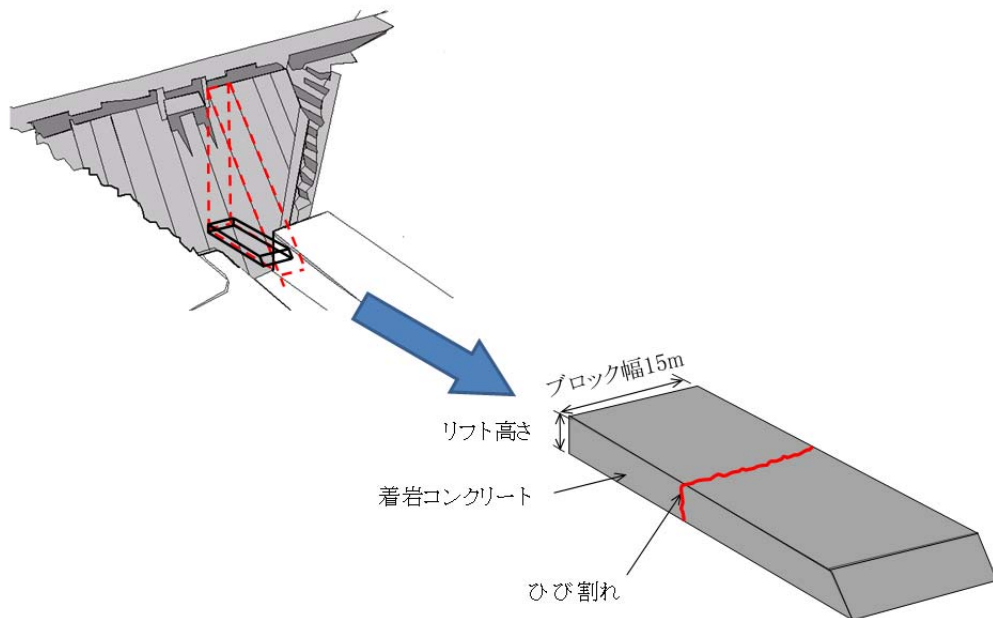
着岩コンクリートに発生するひび割れの例
